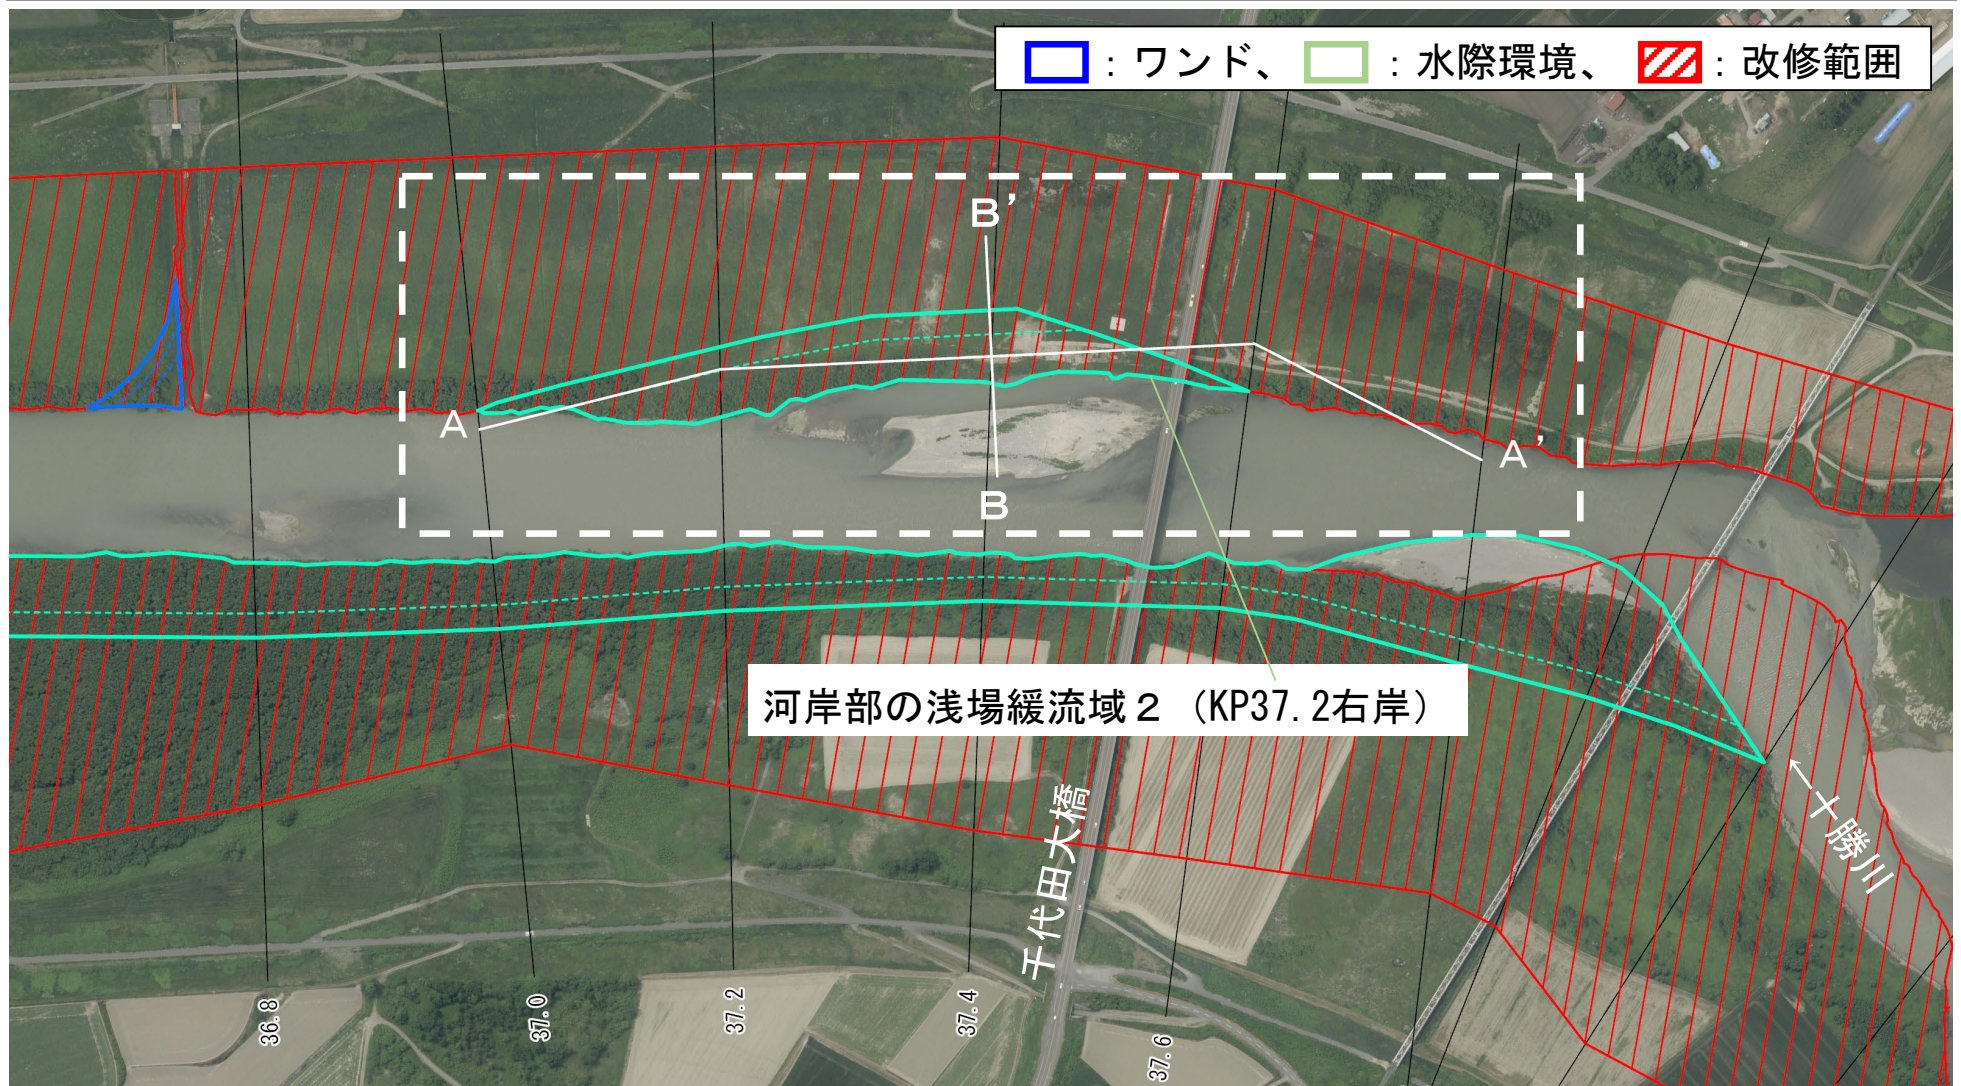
河岸部の浅場緩流域 2 (KP37.2 右岸) の平面配置図
